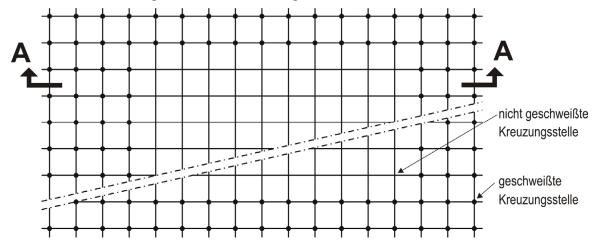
Zulässige Bereiche der Schweißung (hier dargestellt für nicht gestaffelte Bewehrung)
